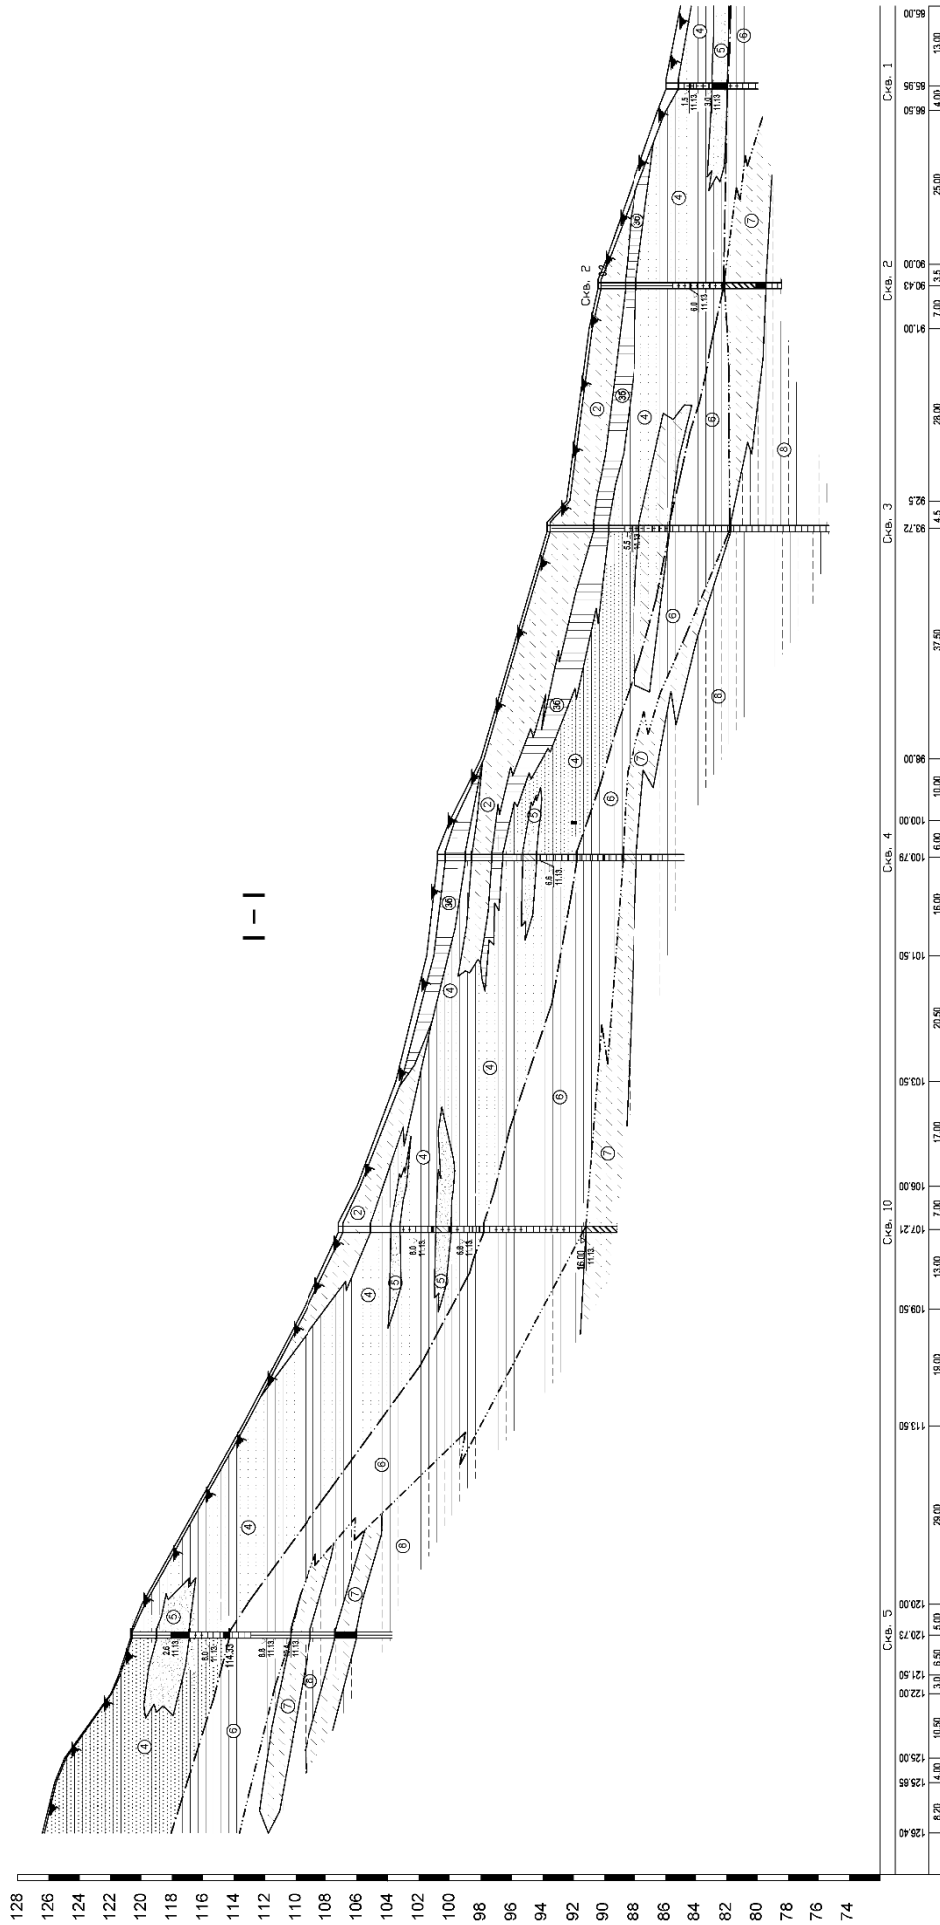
Secțiunea geologică I-I a versantului alunecător. Terenul nr.4, satul Trușeni
